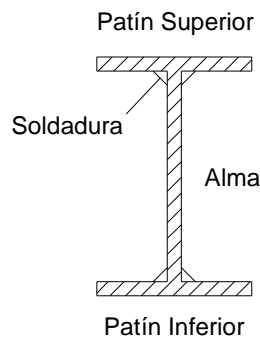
Sección transversal típica de la viga de rigidez. ⁷
